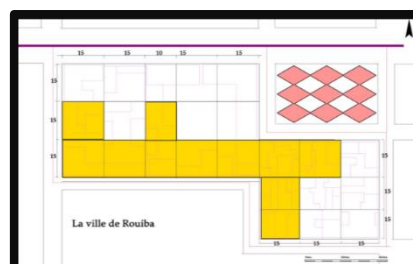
Plan des parcelles donnant sur la voie tertiaire
